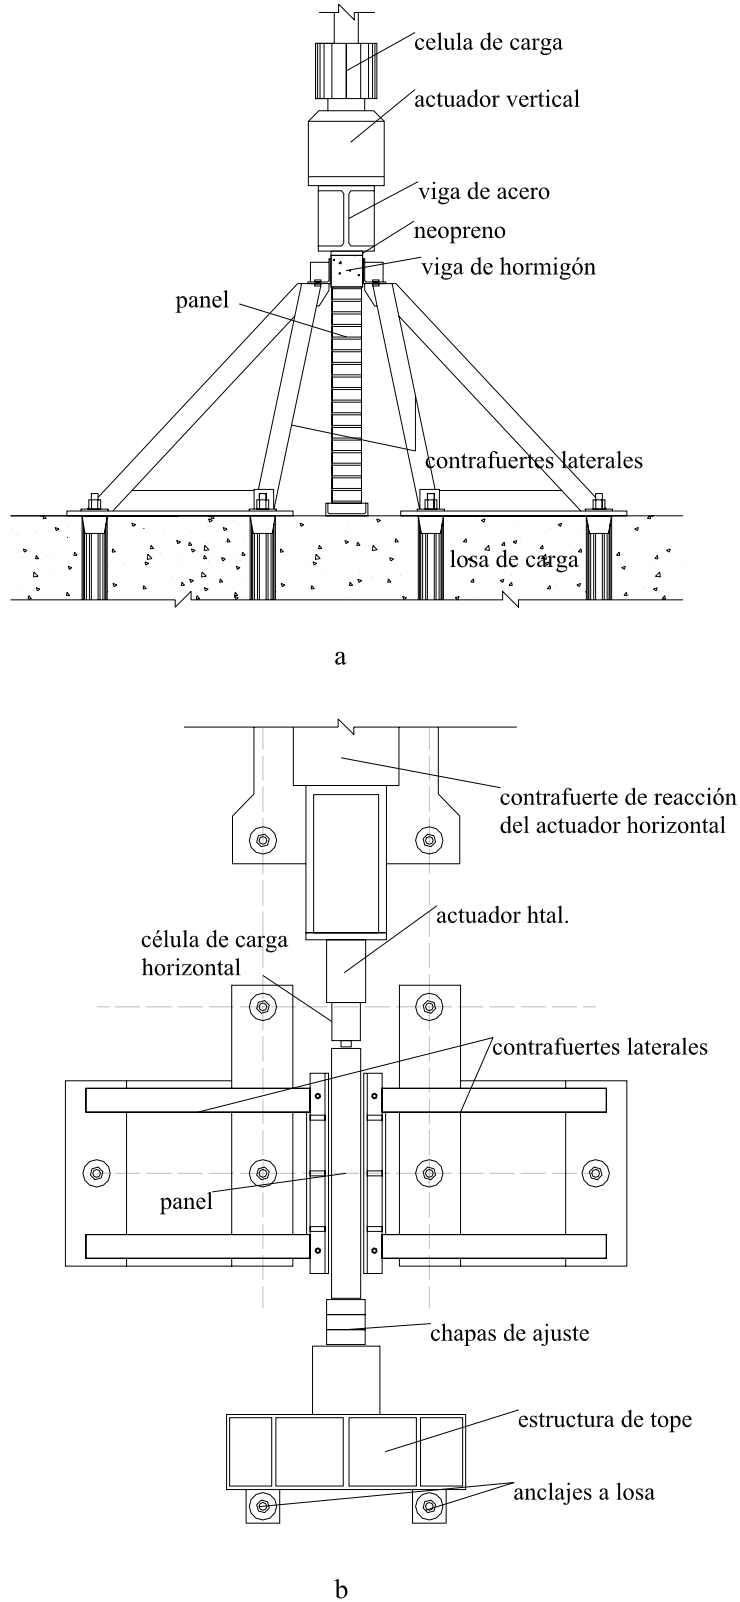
Esquema general de montaje de los ensayos biaxiales: (a) planta (b) alzado.
